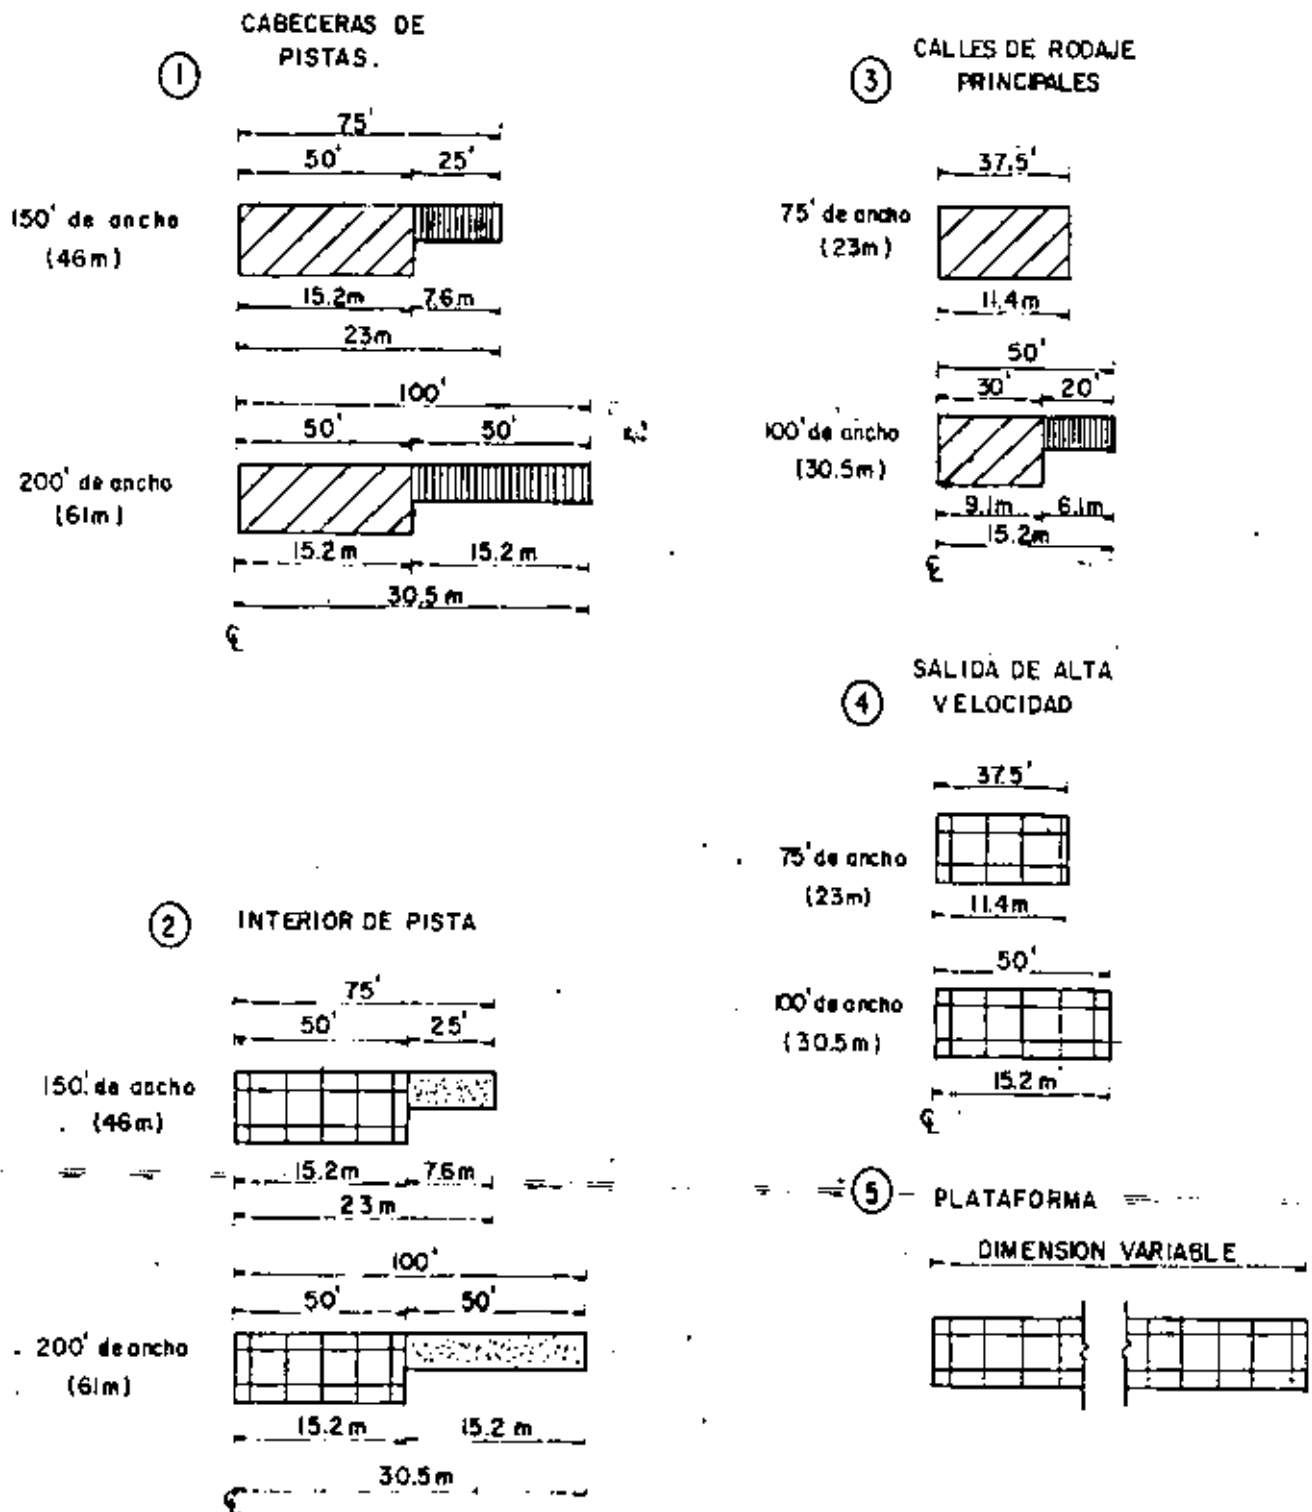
SECCIONES TRANSVERSALES DE PAVIMENTO. Instituto del Asfalto 1973)
